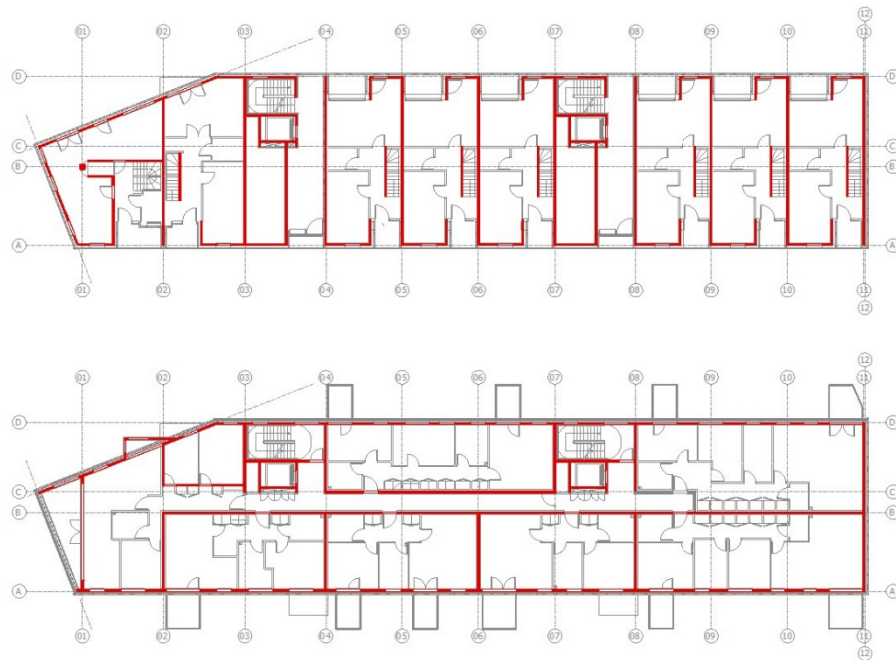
Grundrisse Bridport House © EURBAN Limited
